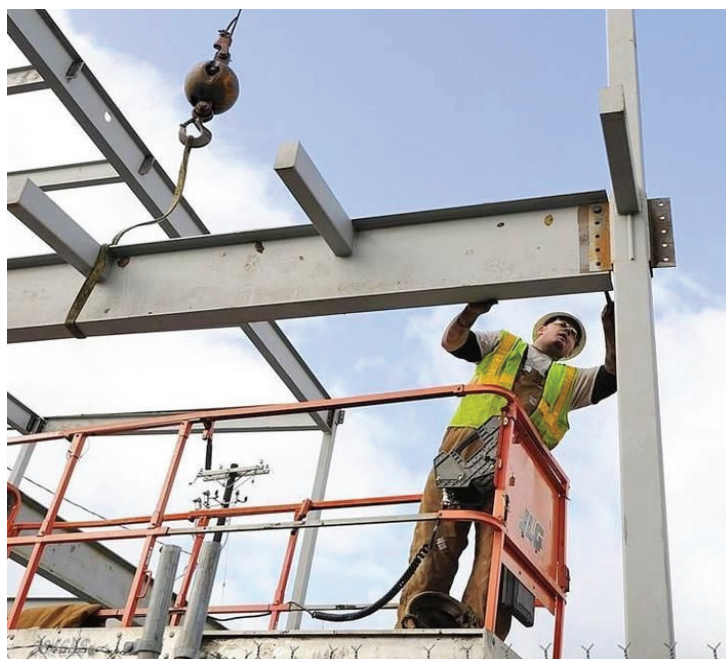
Поэлементный монтаж металлических конструкций.
